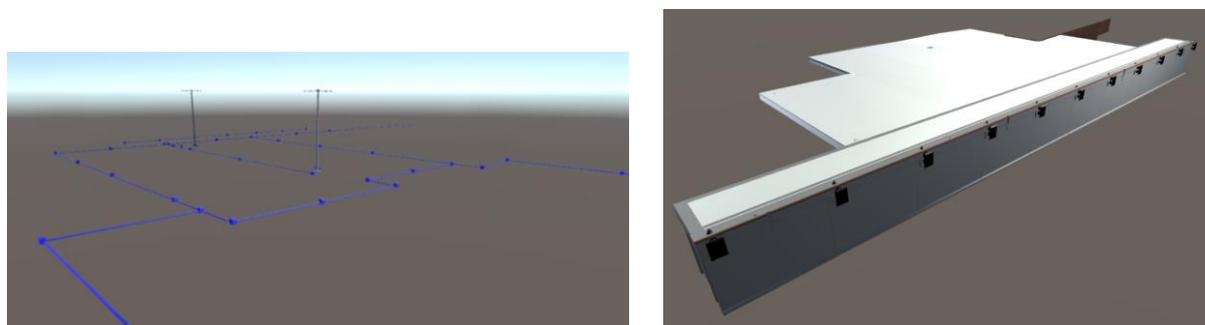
Alumbrado(izda.) y estructuras (drcha.) Fuente: Elaboración propia
